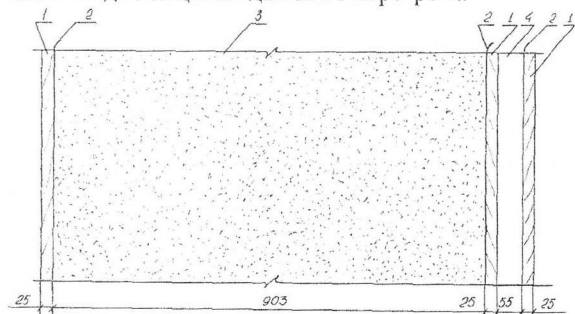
Наземное льдохранилище. Фрагмент разреза наружной стены
